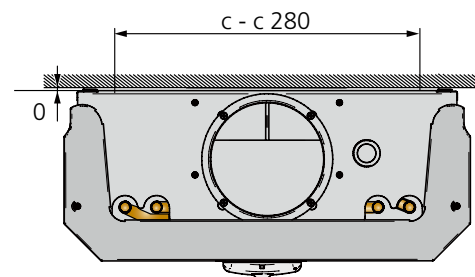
Installation – installation directement contre le plafond à l'aide de l'accessoire ADRIATIC d-T-MD-4S.
